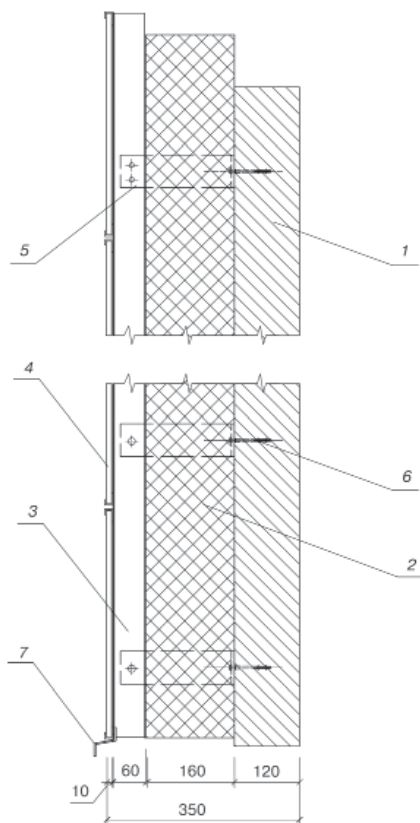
Вертикальный разрез панели наружной стены с НФС ВВЗ: 1 – железобетонная панель; 2 – утеплитель; 3 – вертикальный профиль; 4 – облицовочная плитка; 5 – кронштейн; 6 – анкерный дюбель; 7 – козырек
